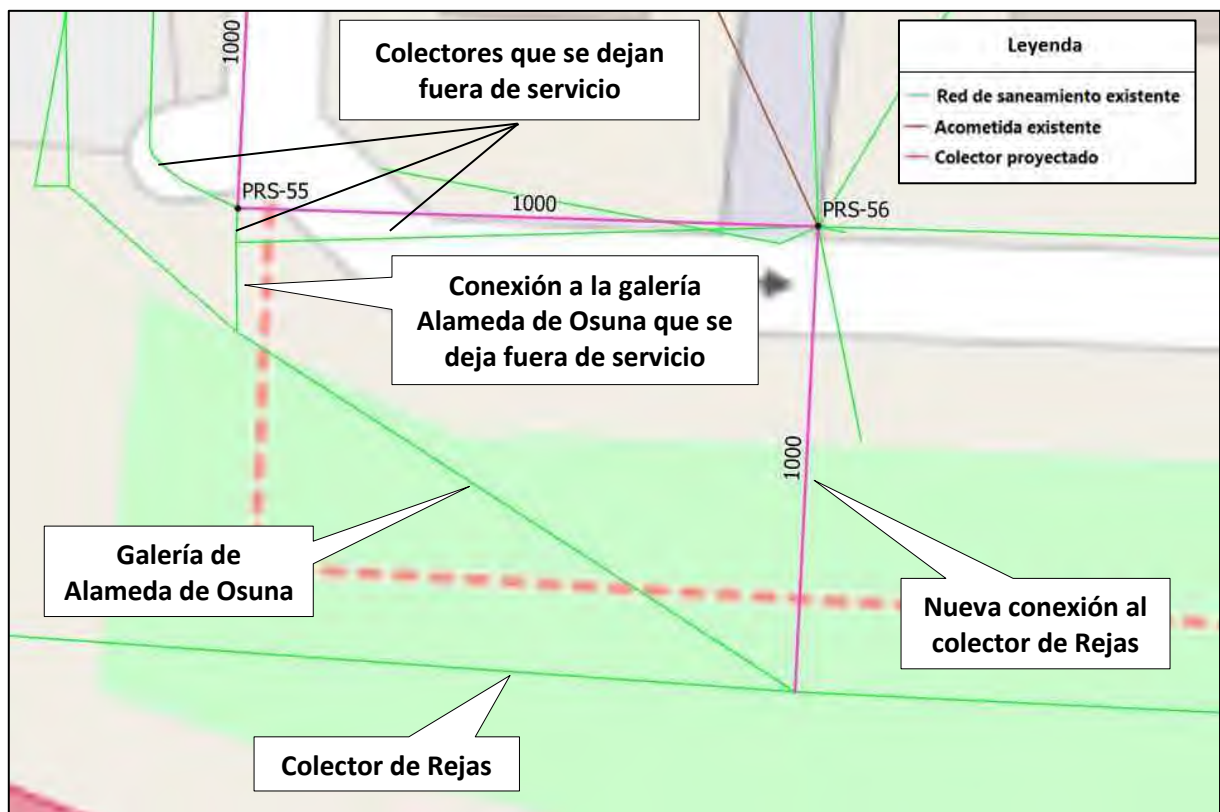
Colector proyectado en la calle Medina de Pomar. Planta de la actuación. Detalle 2.
